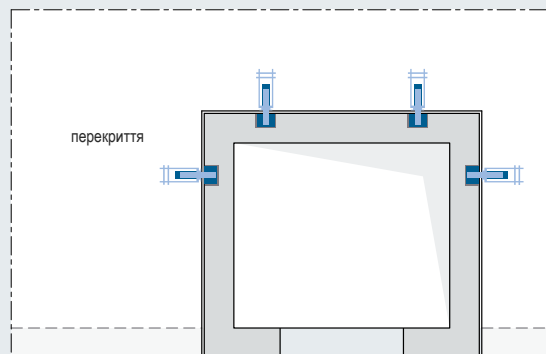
Опирання плит переkritтя на стіни (наприклад, стіни шахти ліфта)
